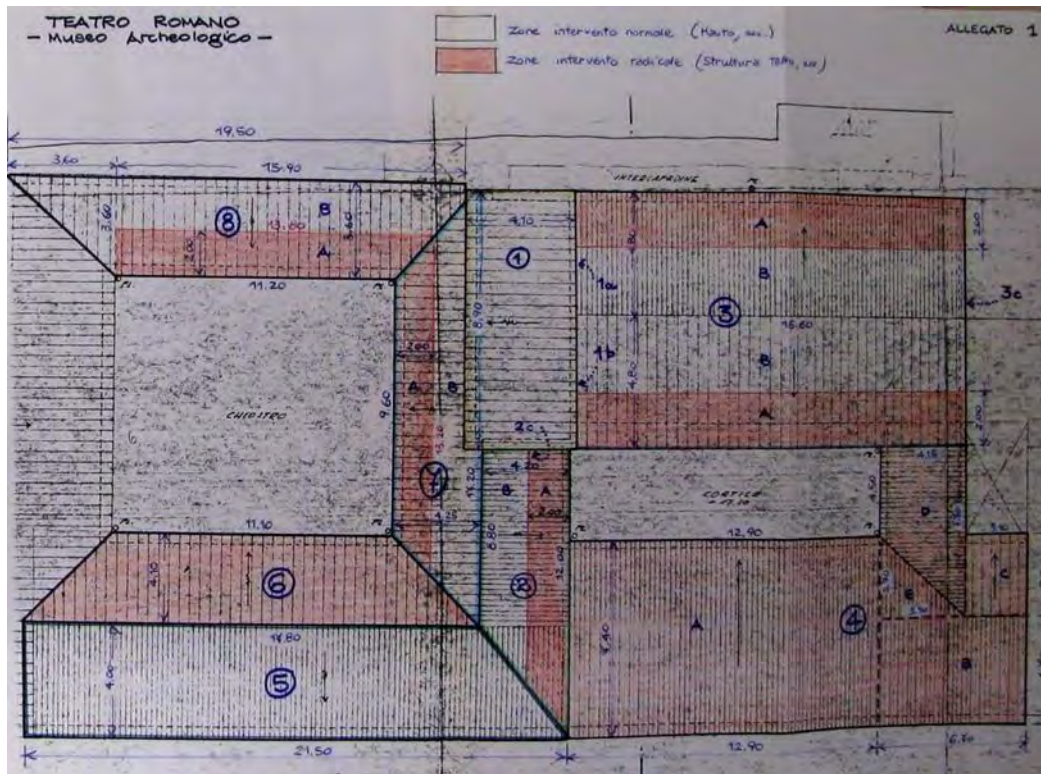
10 - Progetto restauro museo 1985: libretto delle misure_allegato 1_pianta coperture
